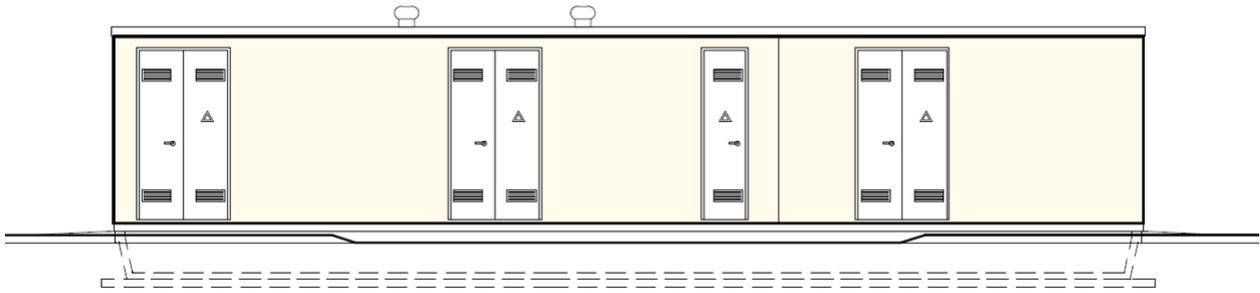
Prospetto frontale della cabina MT/BT in progetto
